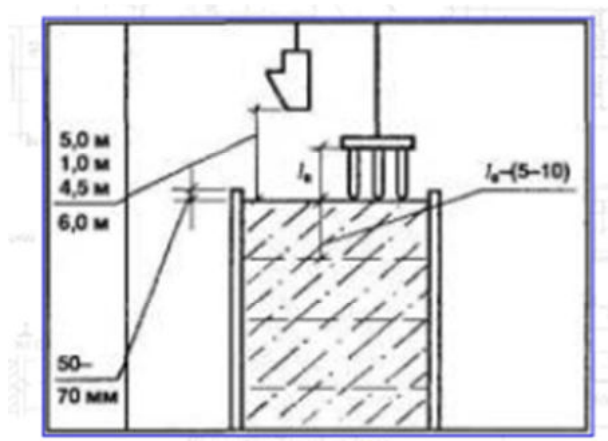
допустимые отклонения при укладке бетонной смеси
